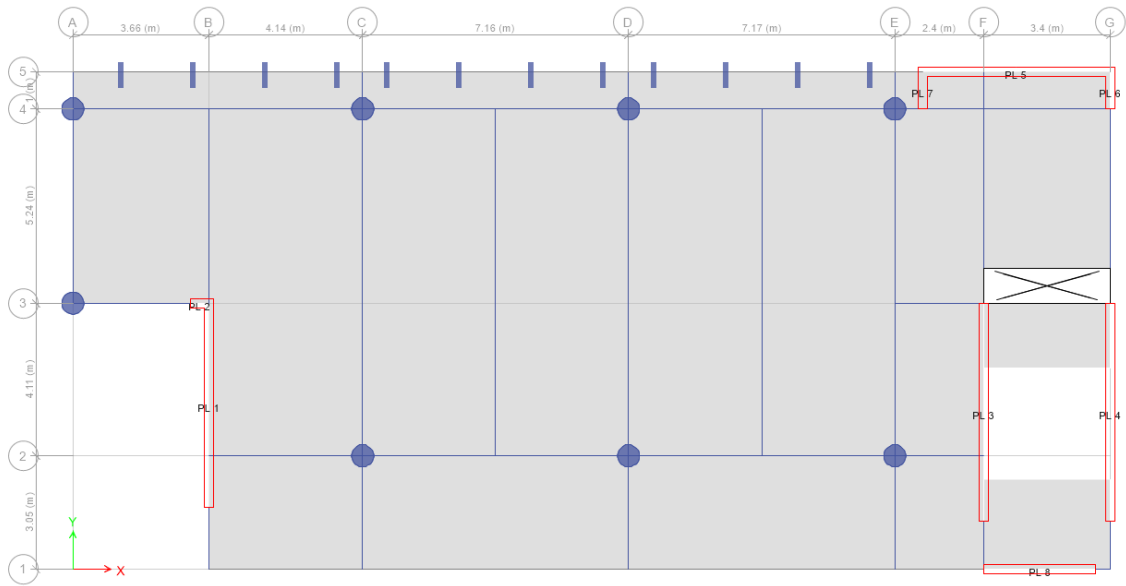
Vista en planta del modelamiento del pabellón D (ETABS 2016)
